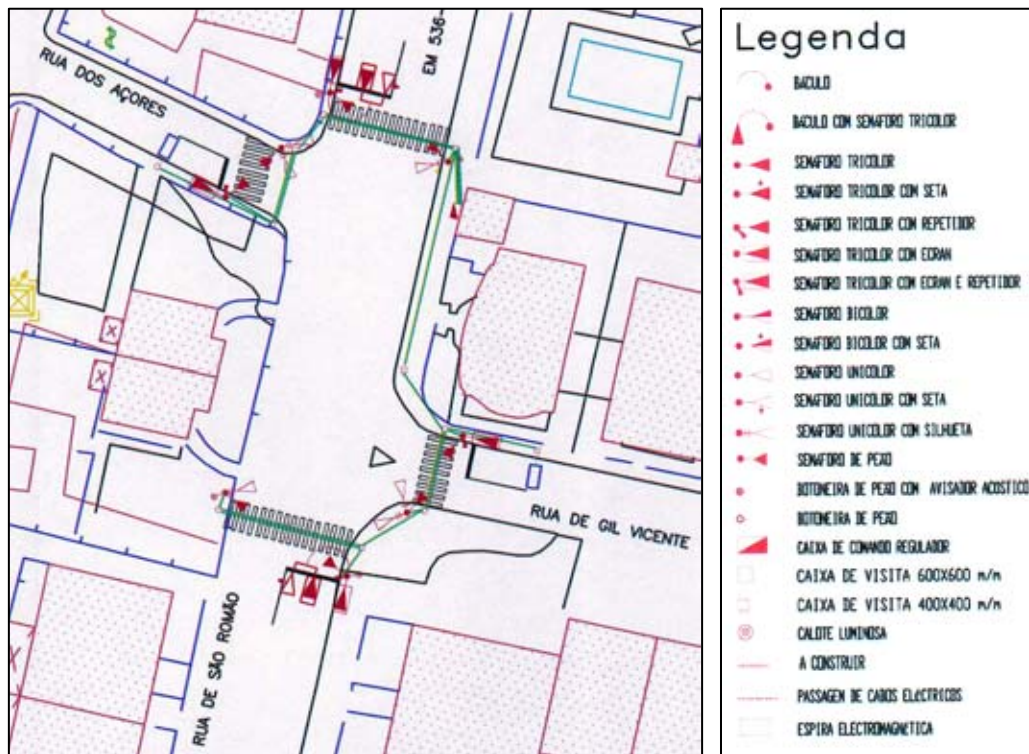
Planta Geral da Instalação Semafórica, na Rua de S. Romão
